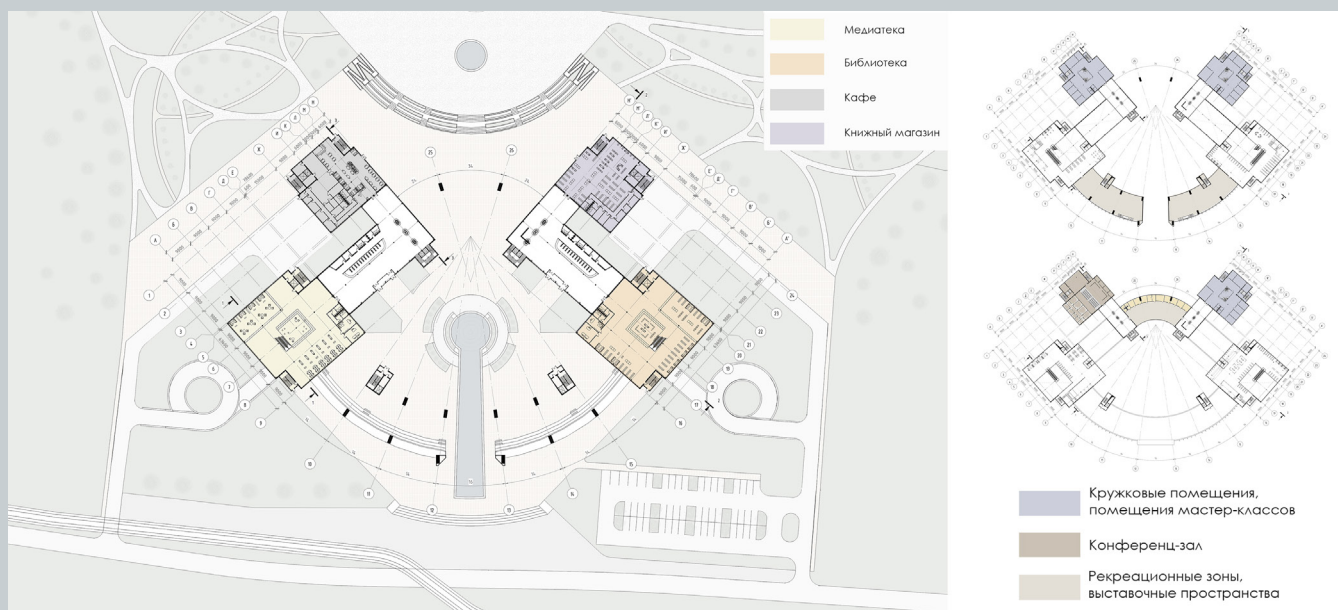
План 1-го этажа. Планы 2-го и 3-го этажей
